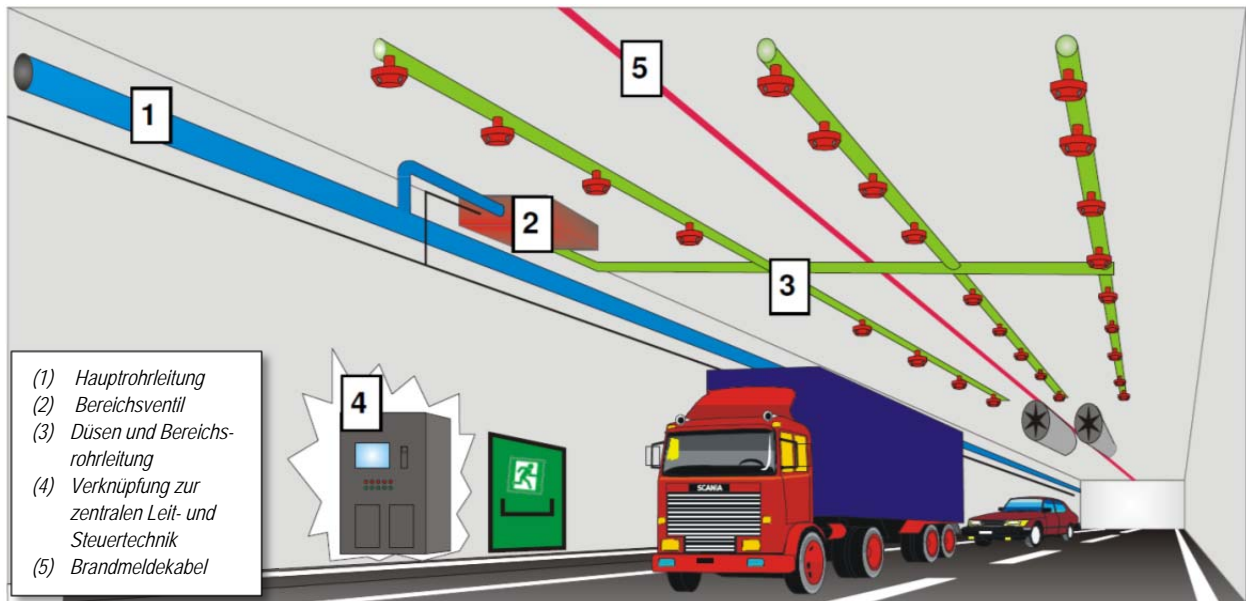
Elemente einer stationären Brandbekämpfungsanlage für Tunnel (Quelle: SOLIT 1&2)
